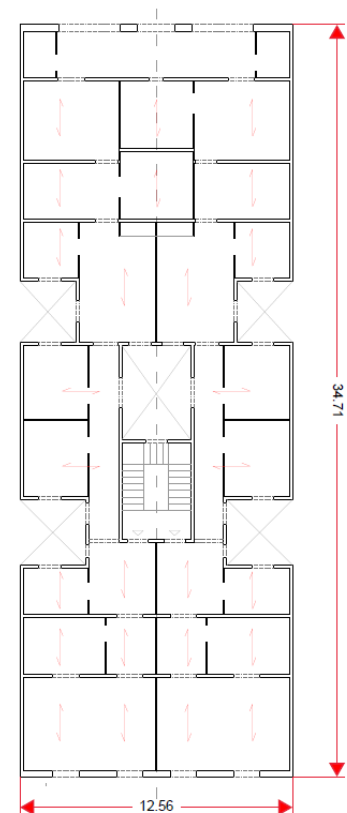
Plano estructural de la distribución en planta del edificio de la calle de Consell de Cent 364 extraído de Cornadó (2015)
